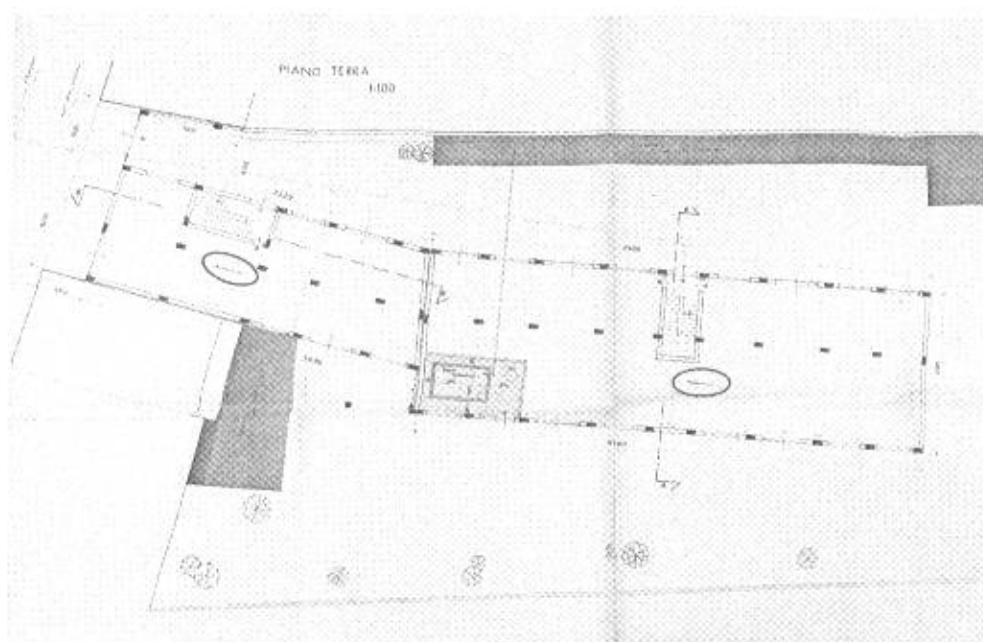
Pianta piano terra Concessione Edilizia n. 1569 del 25.07.1978.
